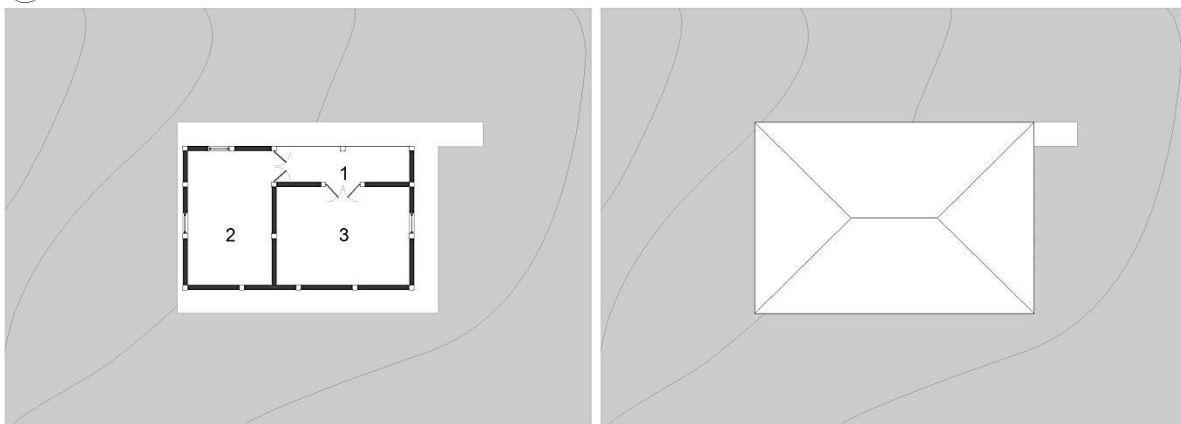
Planta Arquitectónica vivienda de bloques de concreto. Autor: Paúl Rivas Rivas.
